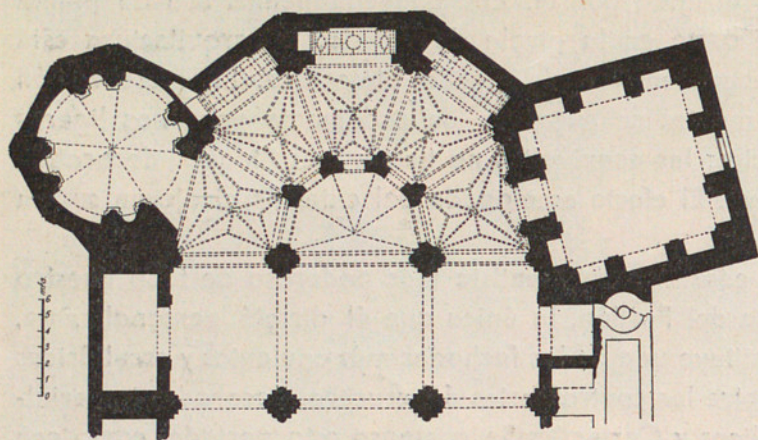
PLANTA DE LA CABECERA DE LA CATEDRAL DE GUADIX.
